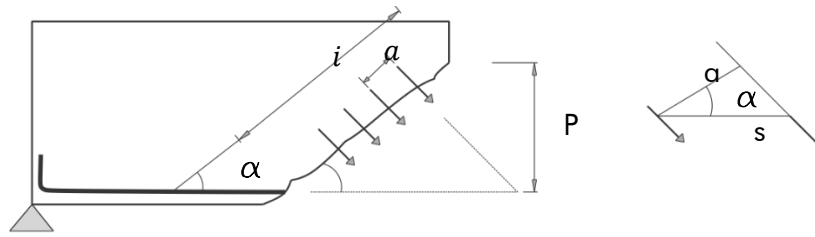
Cantidad de barras que atraviesan la fisura
